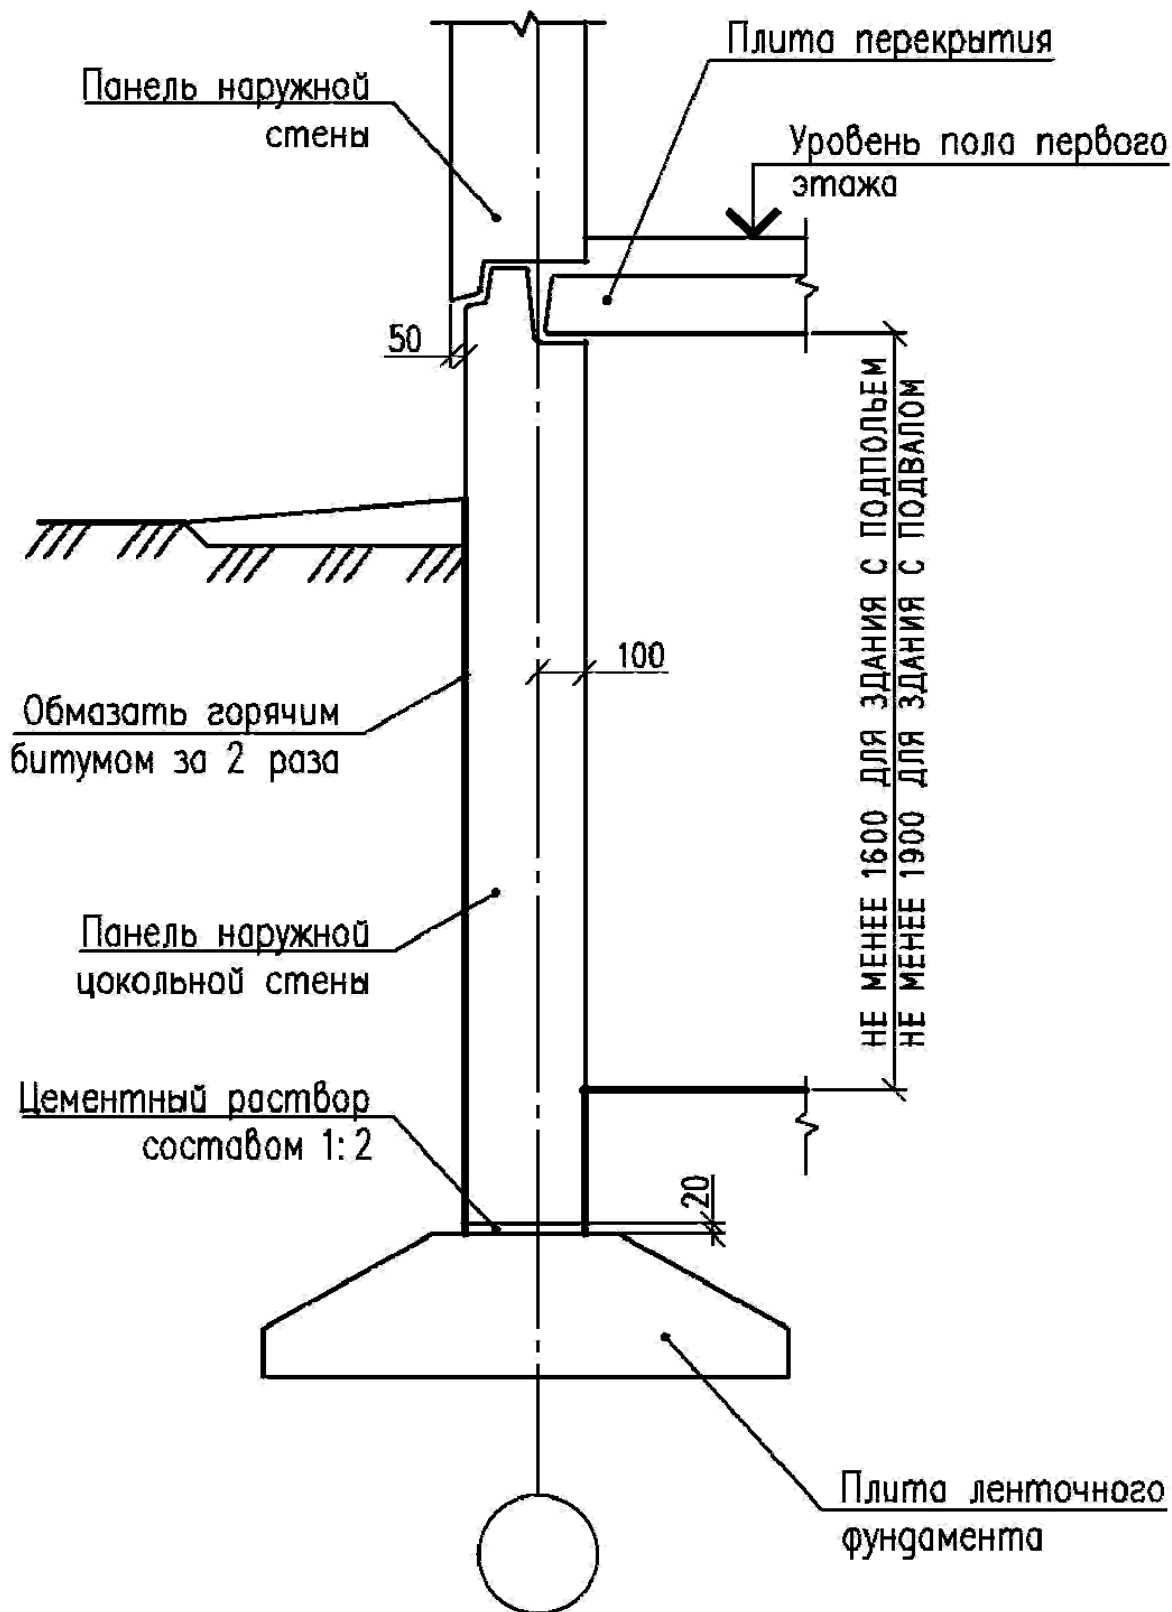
Сборный железобетонный ленточный фундамент под несущую наружную стену
